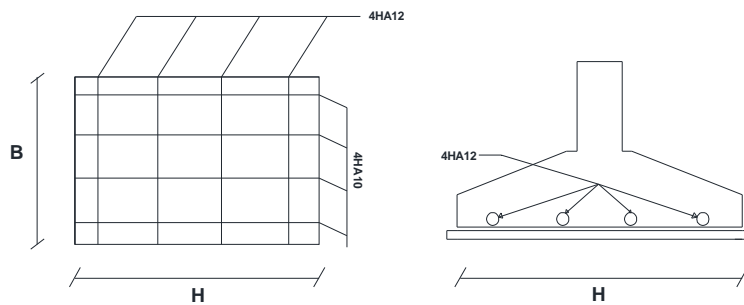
Schéma de ferrailage de la semelle de potelet.
